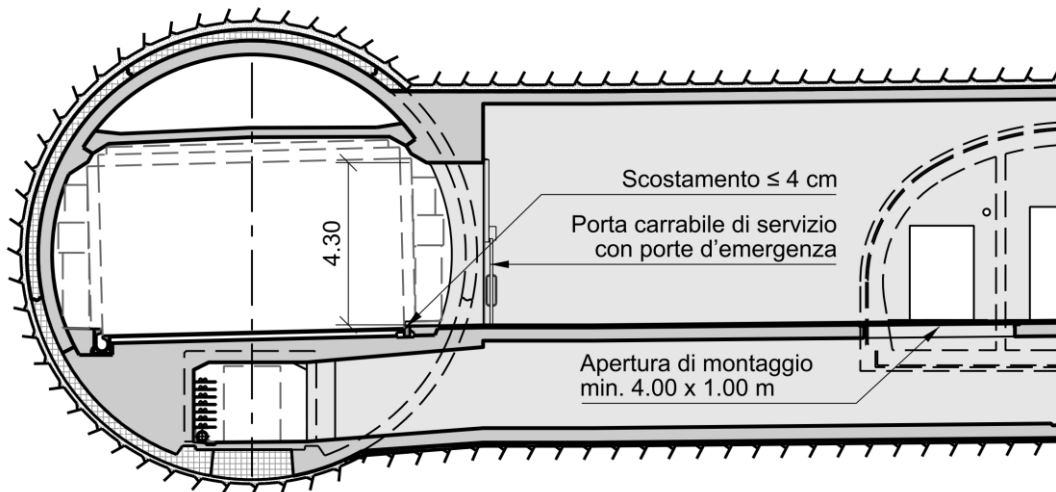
Sezione longitudinale con apertura di montaggio verso il canale tecnico
